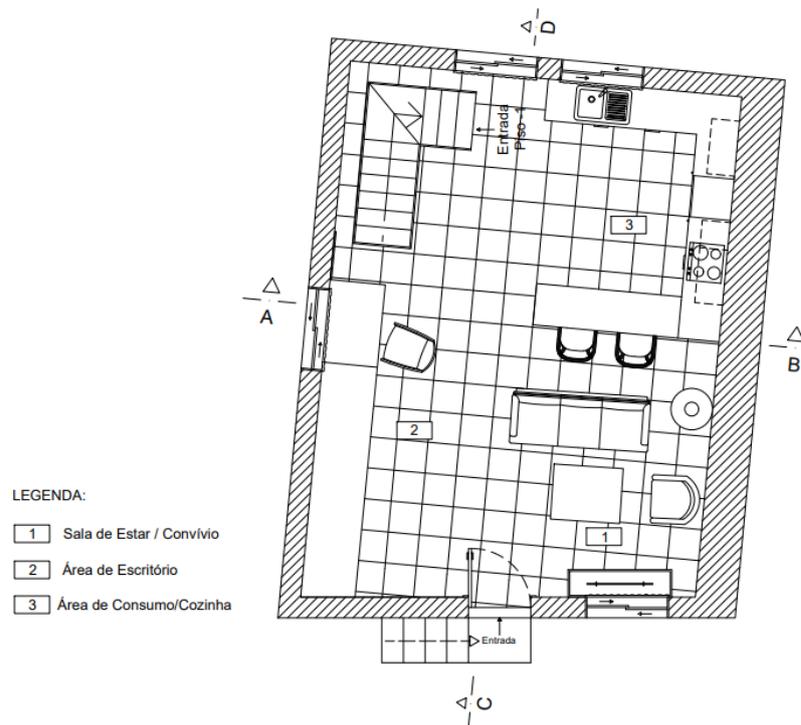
Planta de apresentação do piso 0 ou R/chão. Fonte: Maria Leonor.
